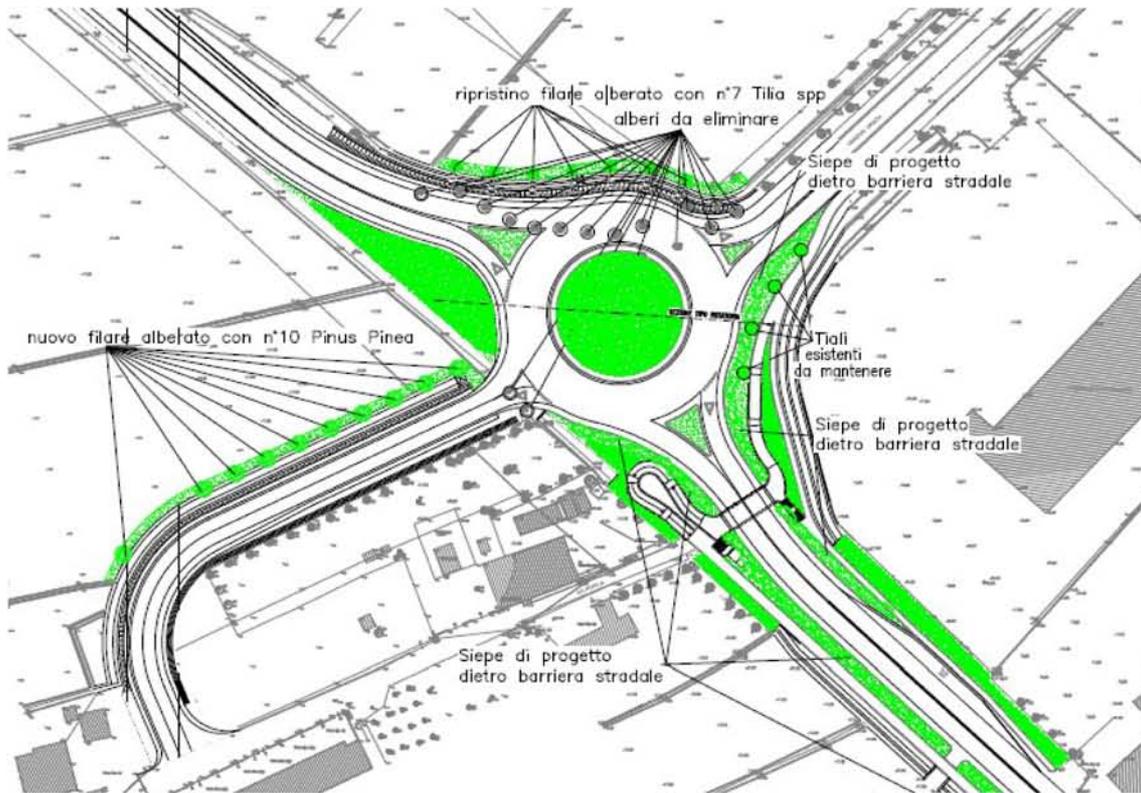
stralcio della tavola 16 Planimetria opere a verde
